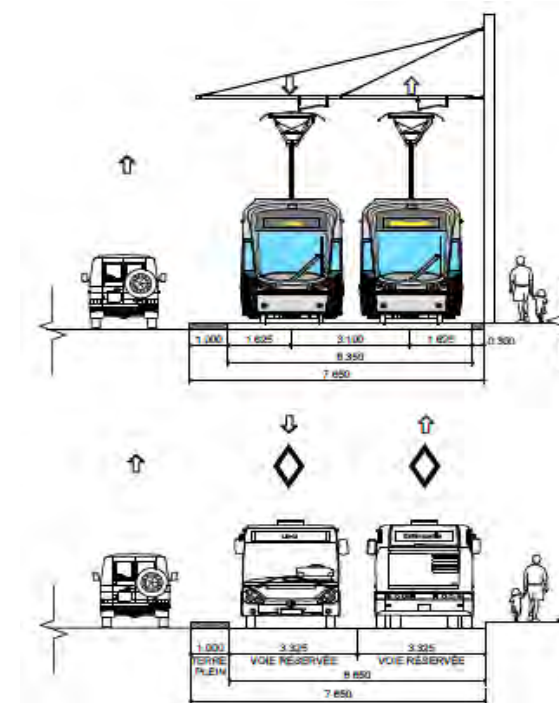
Coupe type 04 de 15 - SRB - Site espace restreint - Insertion latérale
